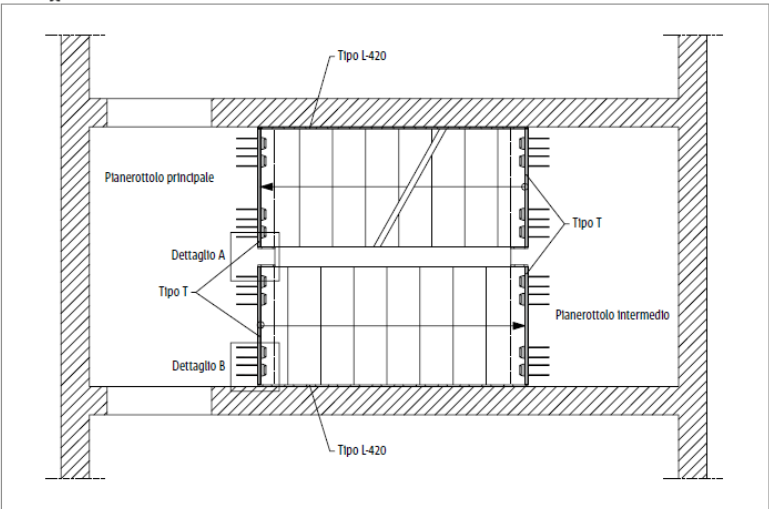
Schöck Tronsole® tipo T, disposizione dell'elemento in pianta
